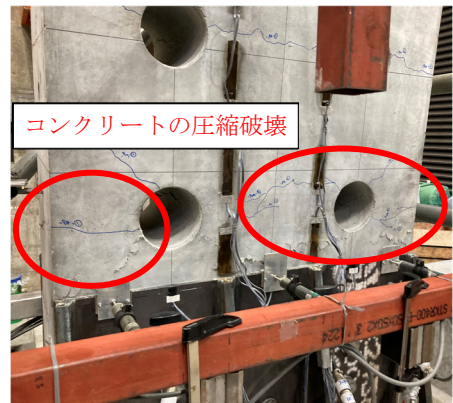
山形鋼天端付近の破壊状況 (No. 2 試験体)
